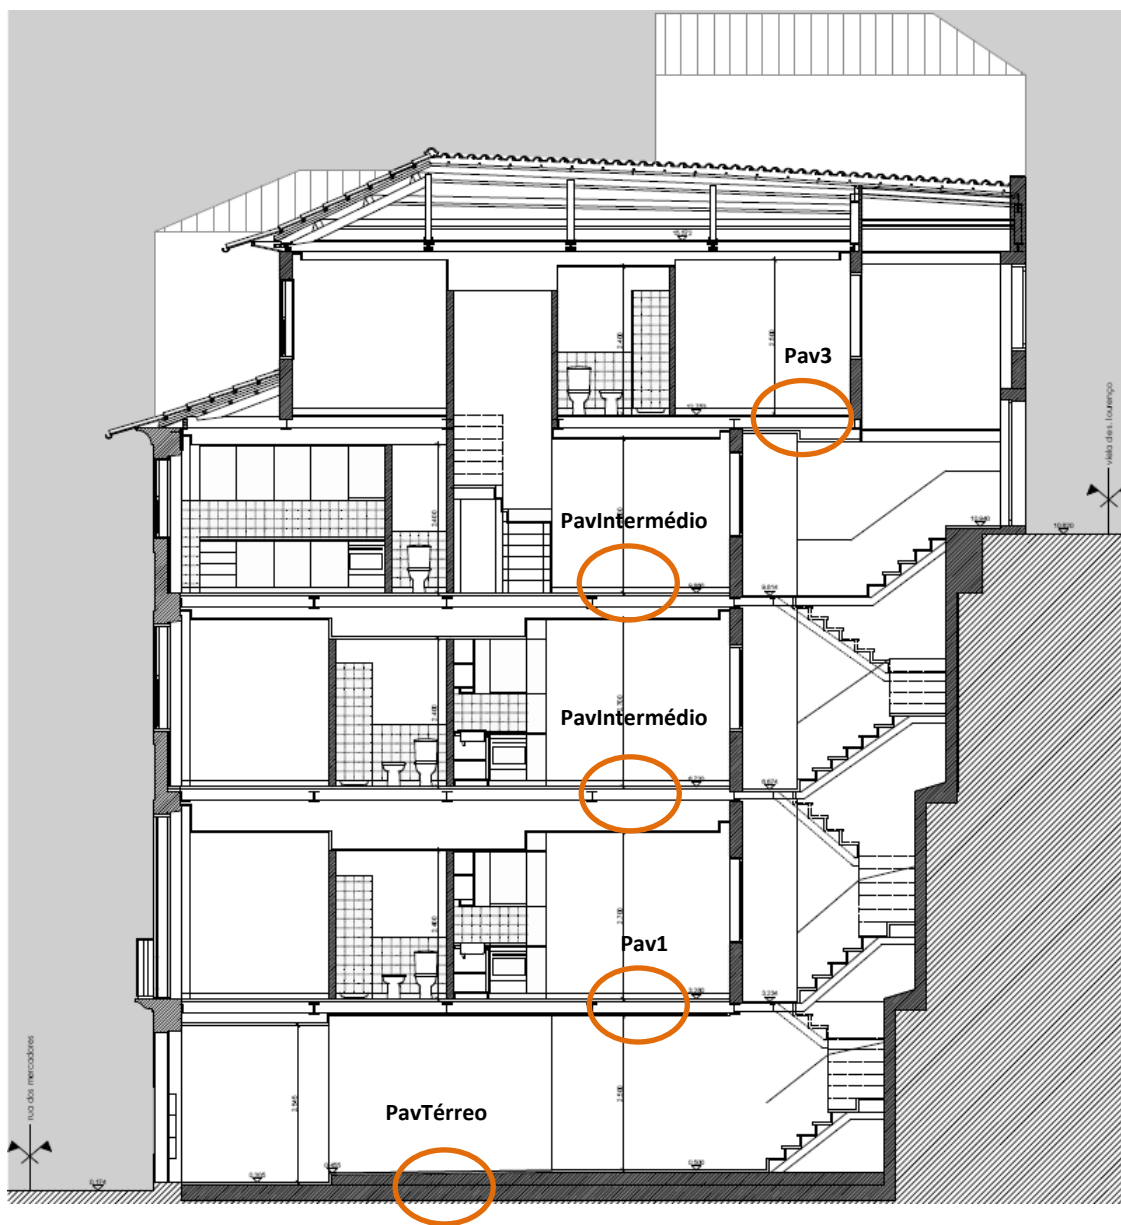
Corte do Projeto 4 com marcação dos pavimentos [19]
